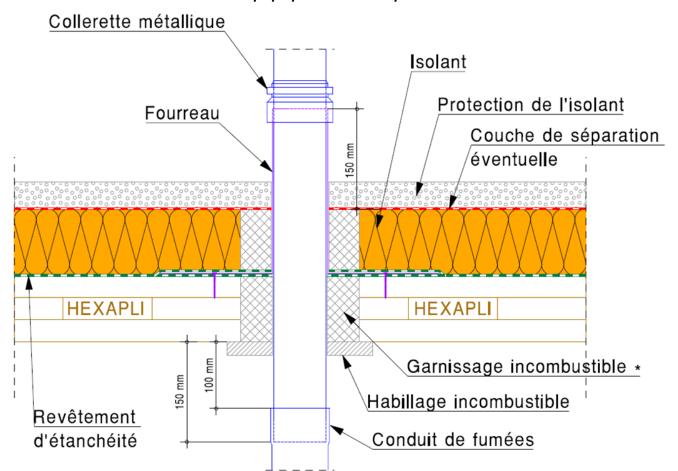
Toiture chaude isolée inaccessible - Traversée de conduit de fumées - (Isolation inversée) Coupe perpendiculaire à la pente
